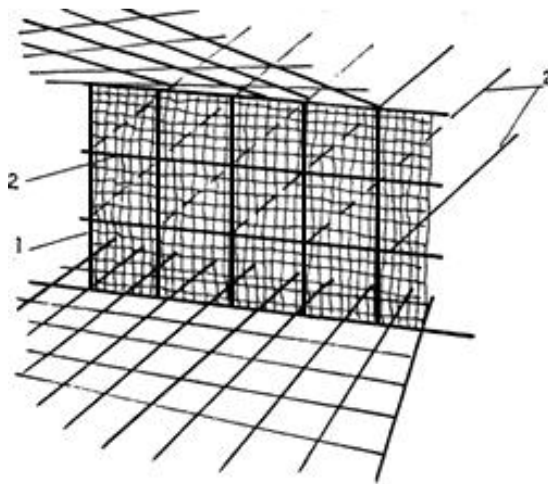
Внутренняя опалубка рабочего шва плиты:
